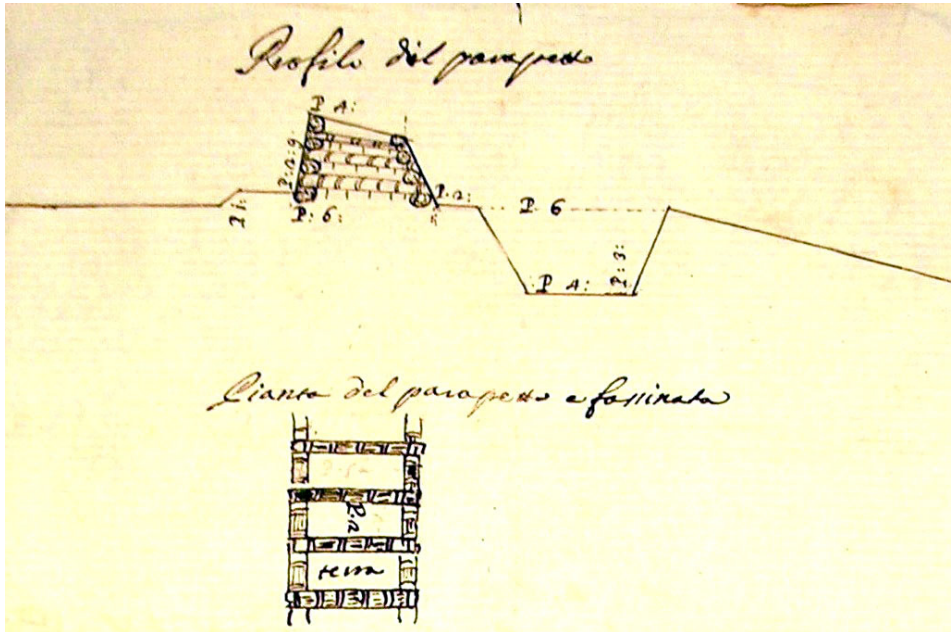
Antonio BERTOLA, *Il parapeto da farsi sopra le colline [...]*, particolare dell'illustrazione con la sezione dell'elevato del trinceramento e della pianta (ASTORIunite, Camerale Piemonte, Articolo 191)
